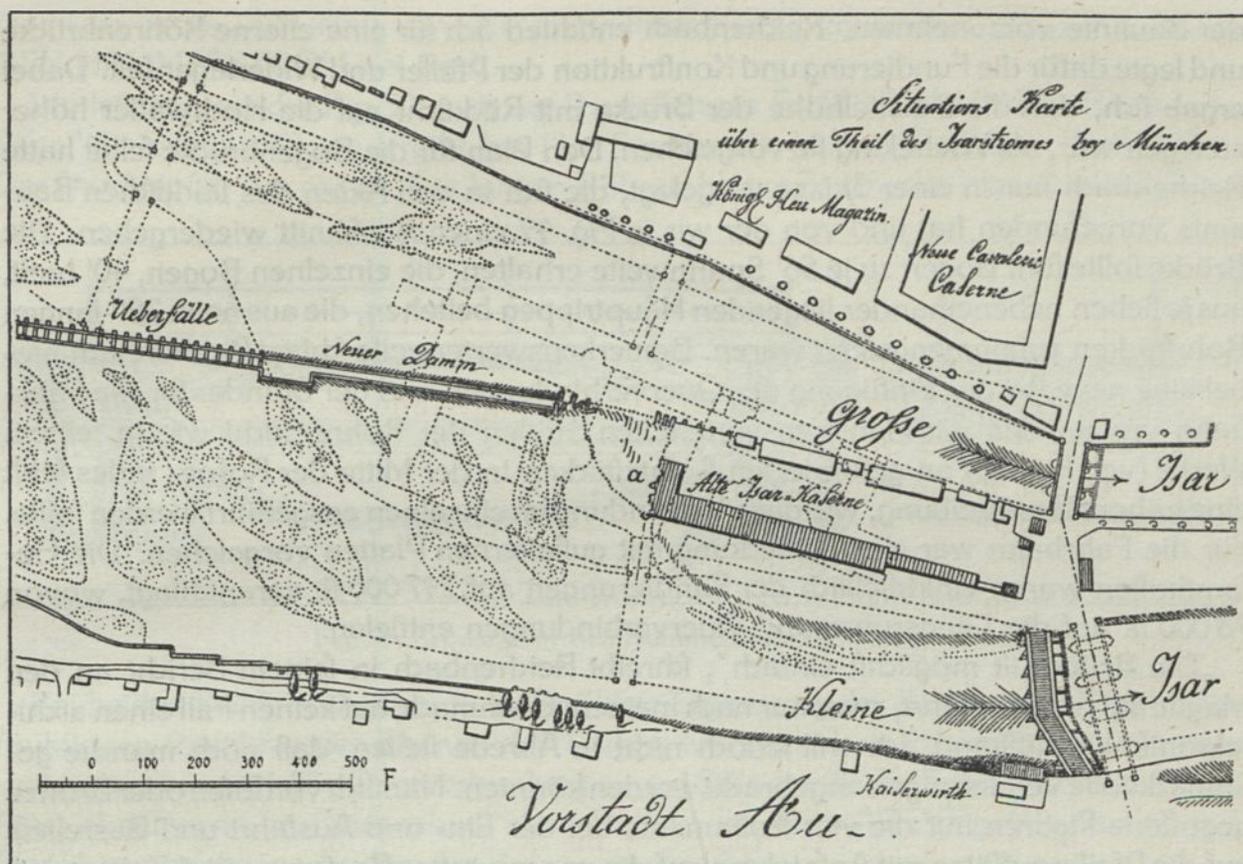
Situationsplan der Museumsinsel mit dem Grundriß der Ludwigsbrücke. 1814.
